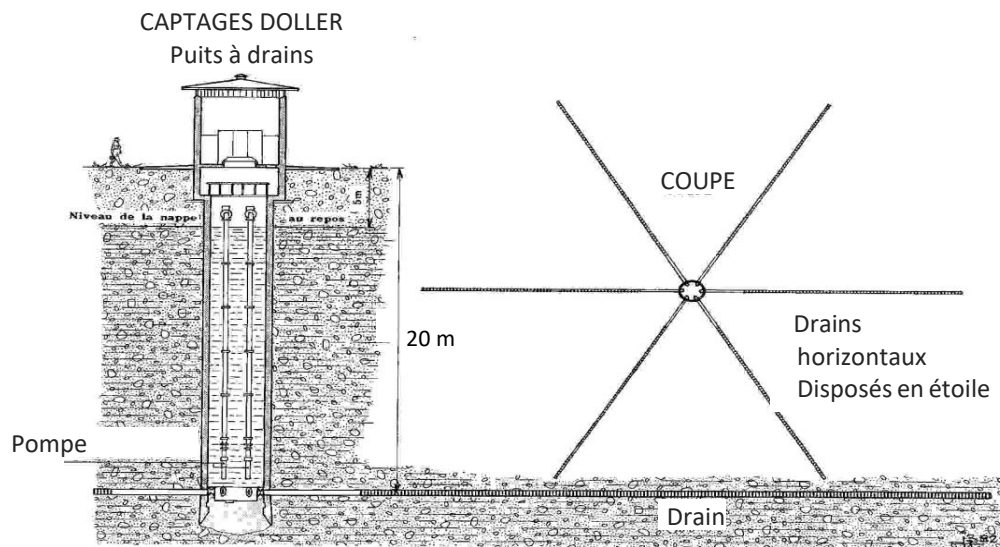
Schéma type d'un drain horizontal (Dupont, 1978)
